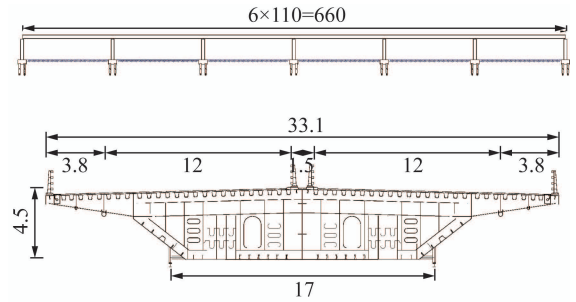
非通航孔 6×110 m 桥跨布置及横断面图 (单位: m)
